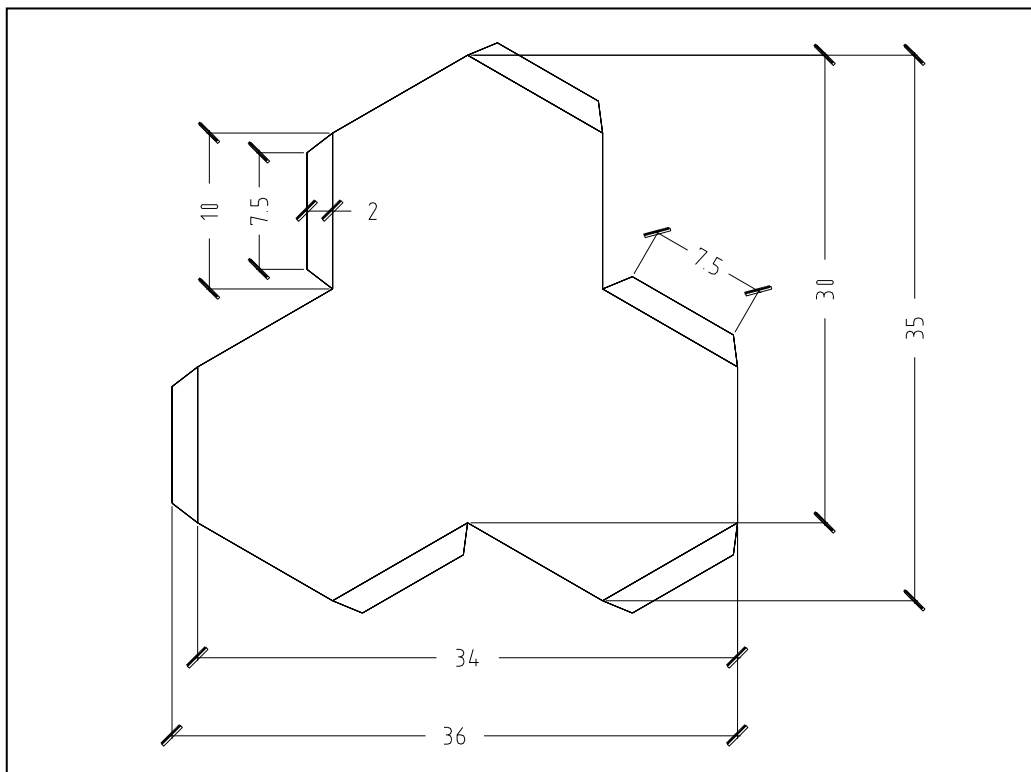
Croquis de una unidad vinculada *Betonplan*®.
